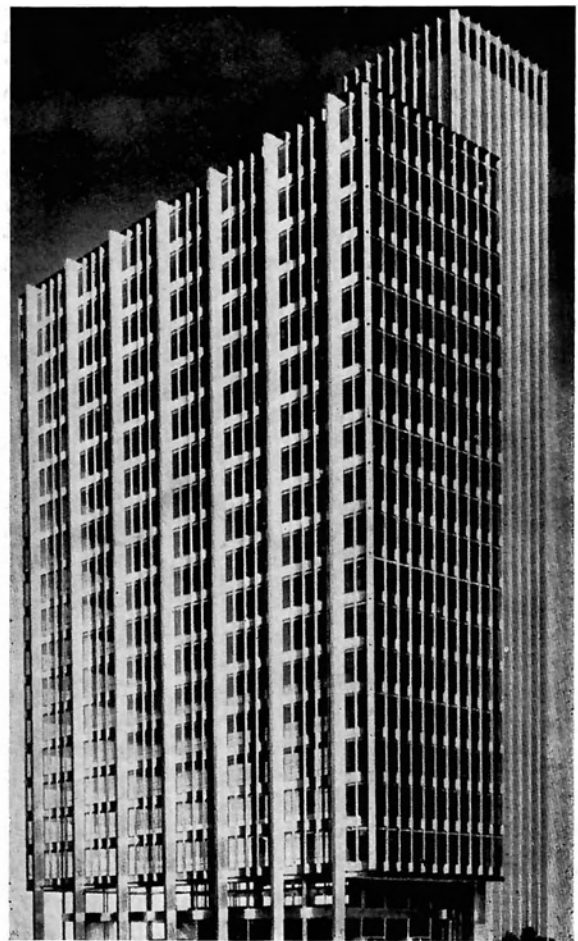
Ansicht vom Inland-Steel-Building (Modell)
